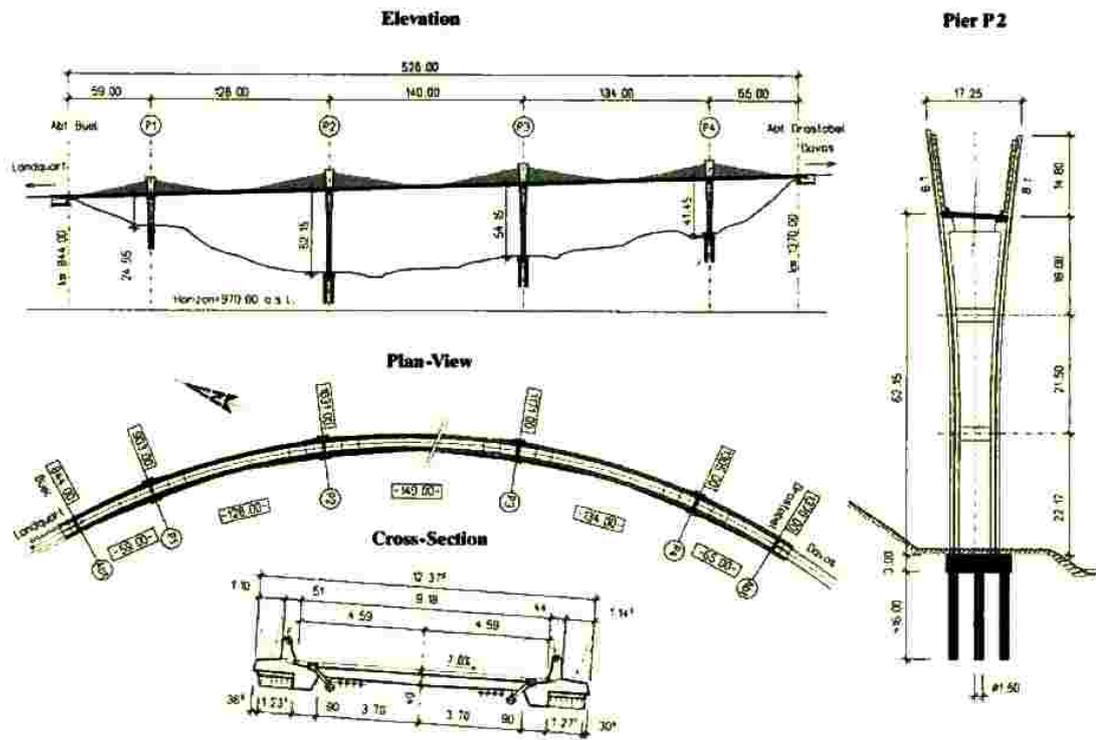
Puente Sunniberg, Planta - Vista - Sección transversal - Torre
